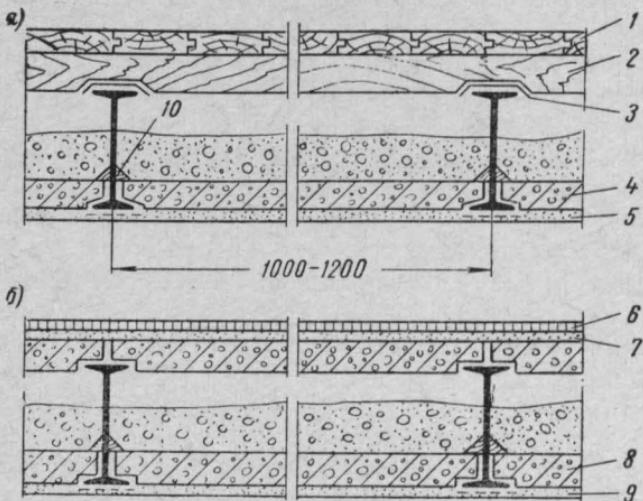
Междуэтажное перекрытие по стальным балкам с заполнением из сборных плит или блоков
